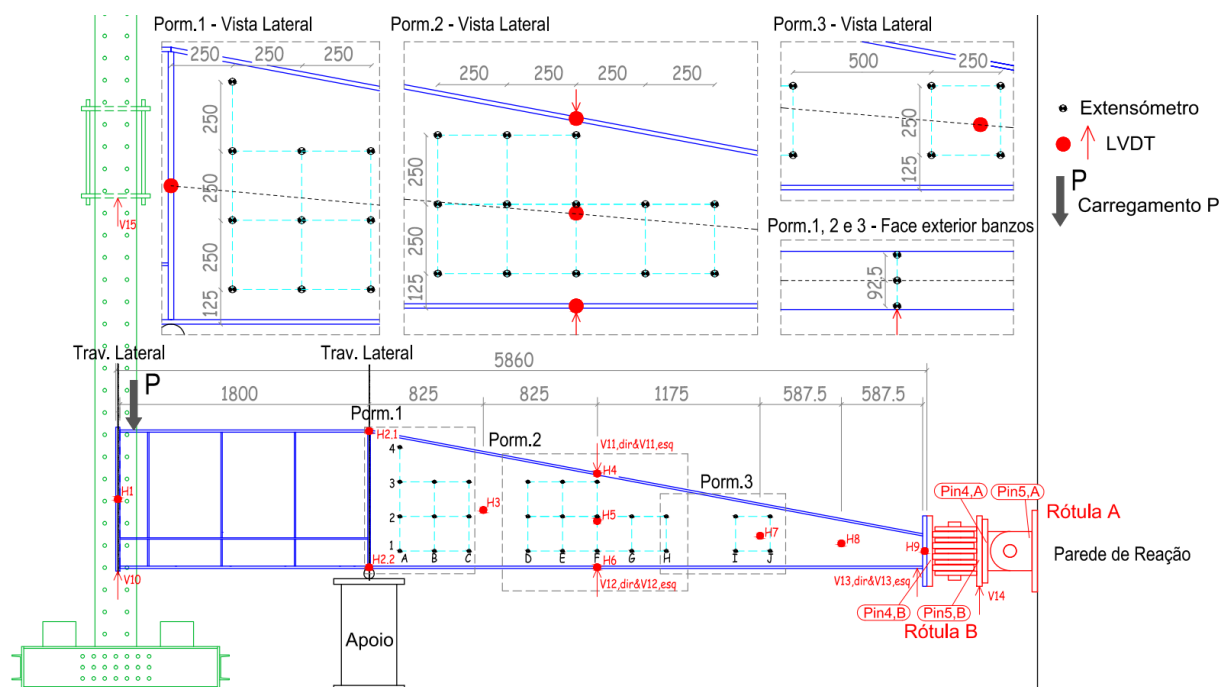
Configuração geométrica de ensaio das Vigas 1 e 2.
